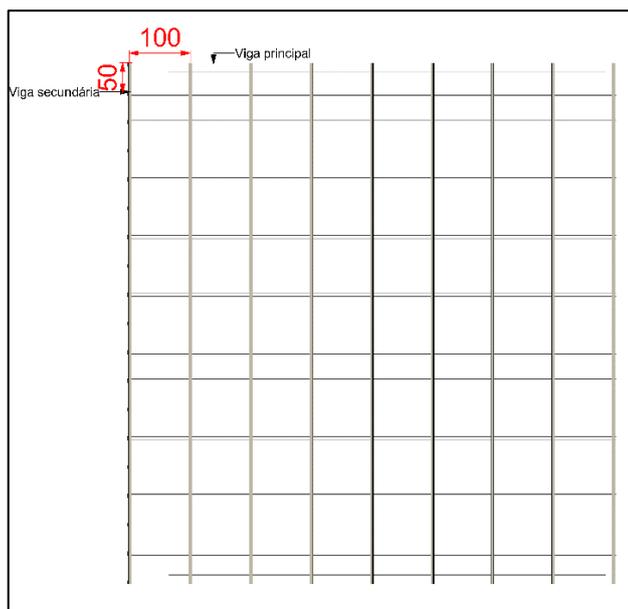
Planta de cobertura aparente para telha fibrocimento
